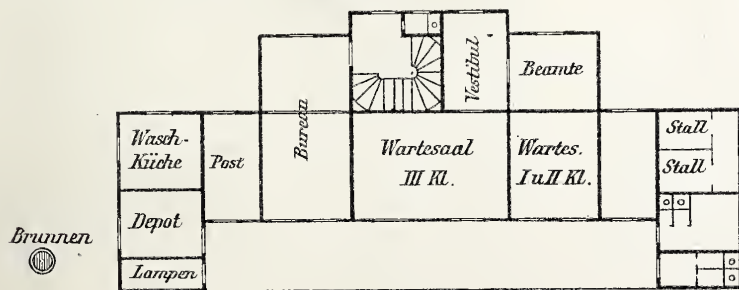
Aufnahmegebäude II. Kl. Grundriss.
